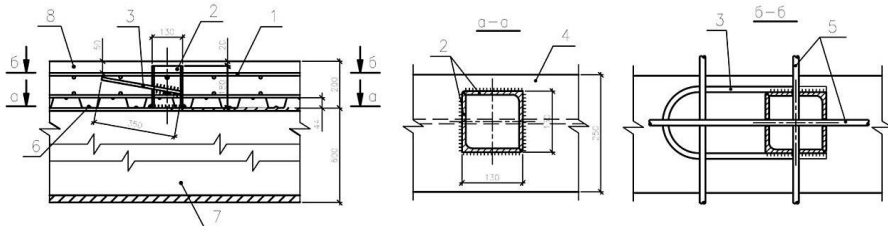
Конструкция дискретно-континуальные связи сдвига: 1 – арматурный каркас плиты; 2 – жесткий упор из уголков; 3 – арматурный выпуск; 4 – верхний пояс балки; 5 – арматура объединения с упором; 6 – профилированный настил; 7 – главные балки; 8 – железобетонная плита проезжей части
